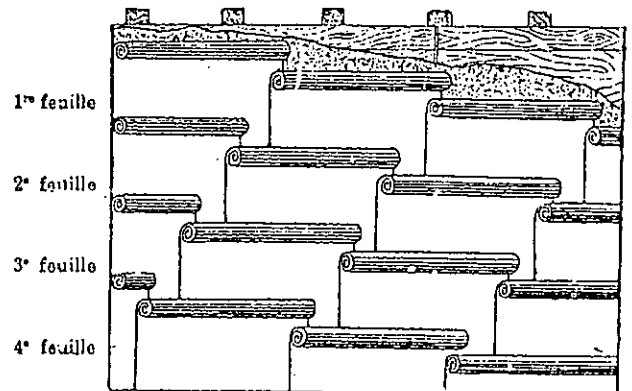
Vue en plan de la disposition des couches de papier d'un toit en ciment volcanique, p. exécution.
